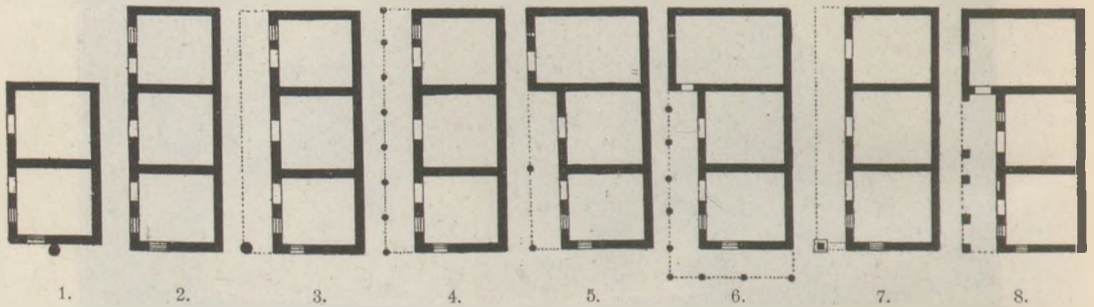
Grundrisse von magyarisches Häusern.
